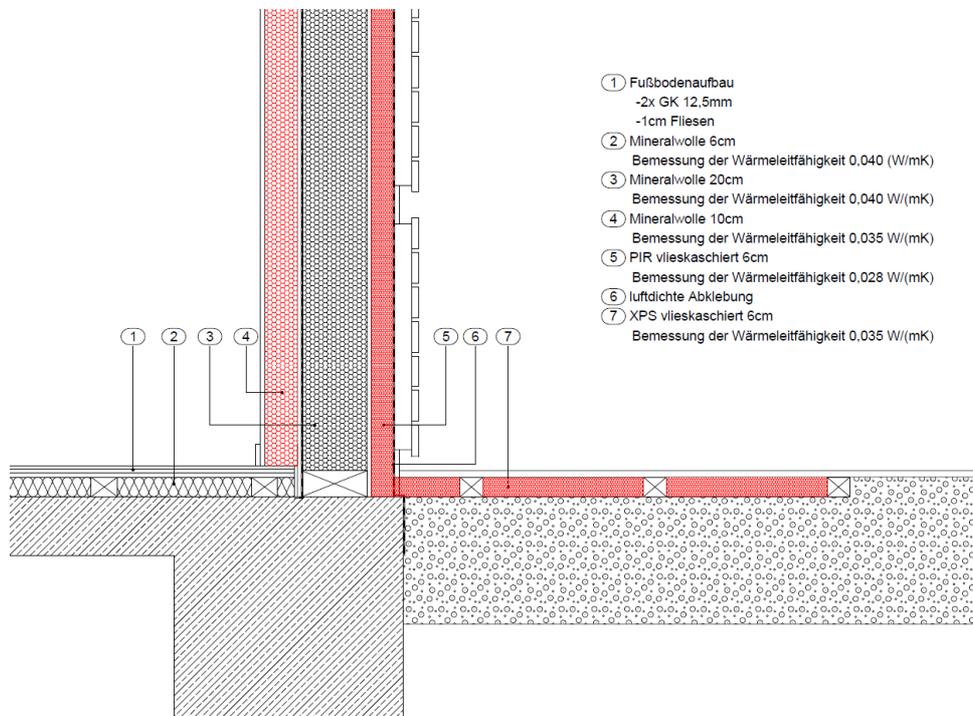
Detail: Sanierung Nordfassade und horizontale Dämmschürze
